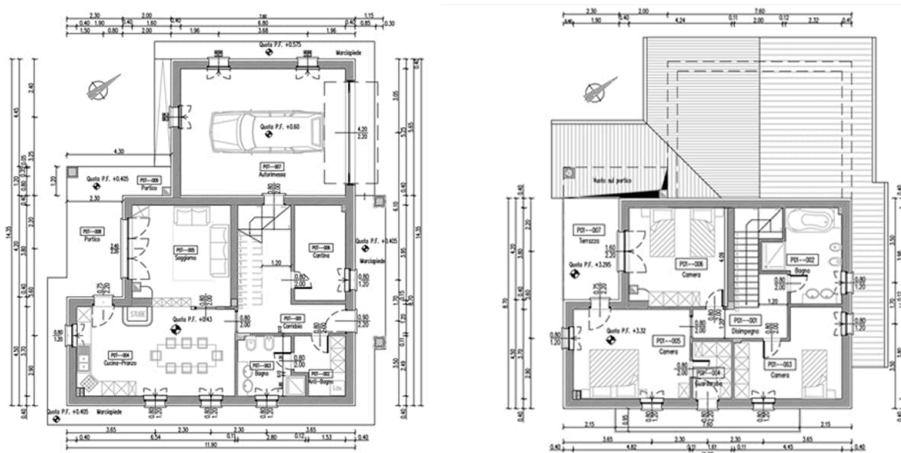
Pianta piano terra e piano primo del fabbricato.
